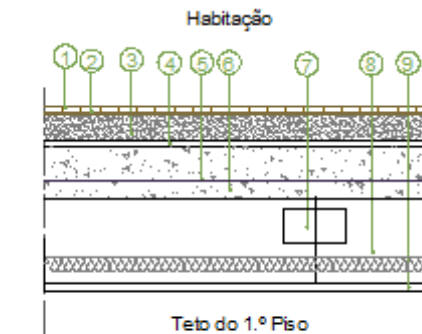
Pormenor construtivo do pavimento 2 [14]
